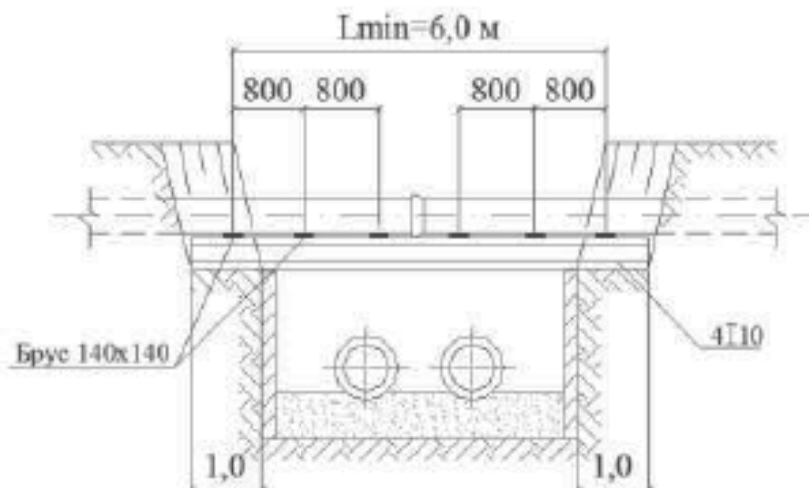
Водопровод или канализация из чугунных или железобетонных труб
